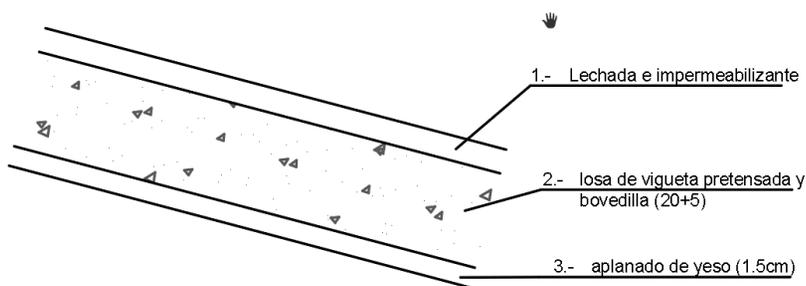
Detalle de cubierta inclinada a base de vigueta y bovedilla
